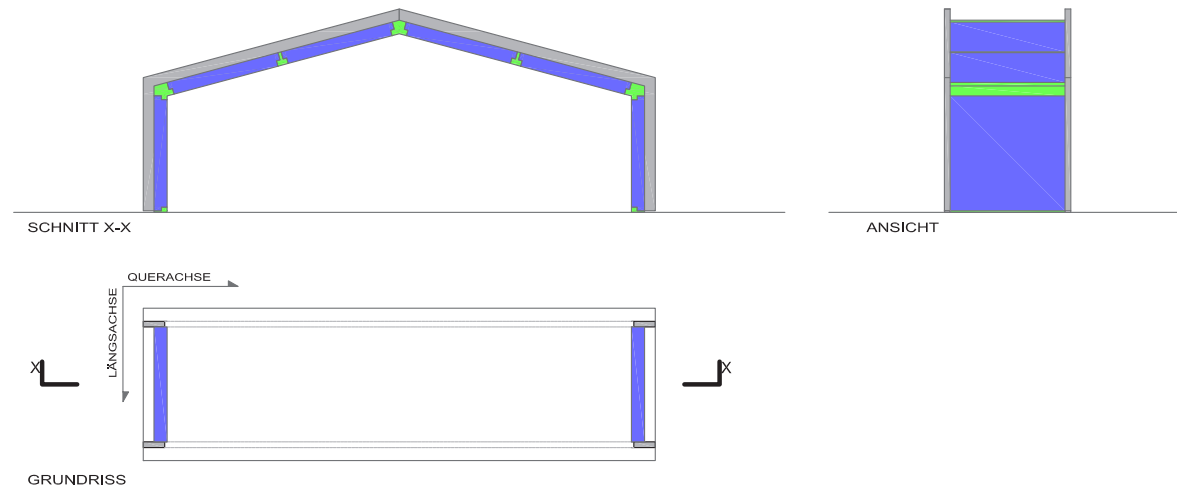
| Systemgrundriss, Schnitt und Ansicht
